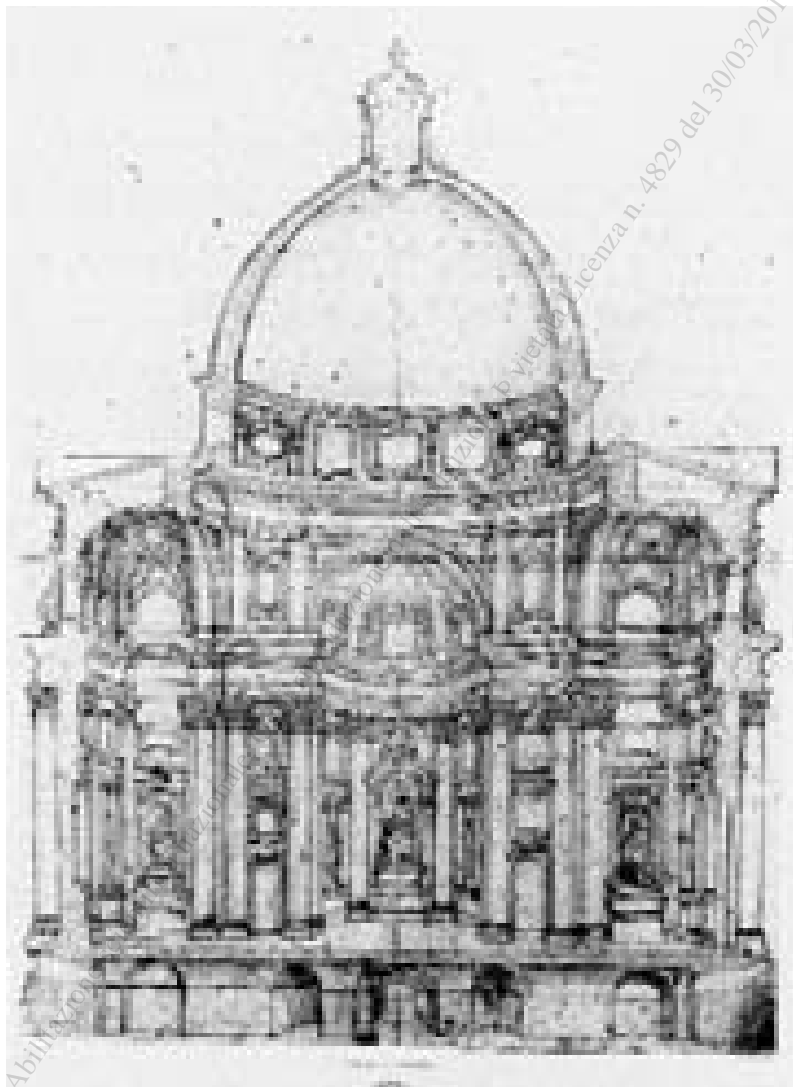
Progetto per chiesa a pianta centrale (Ss. Luca e Martina?): prospetto (copia di D. Martinelli: Milano, Collezione Bertarelli, Martinelli, I, f.50).
